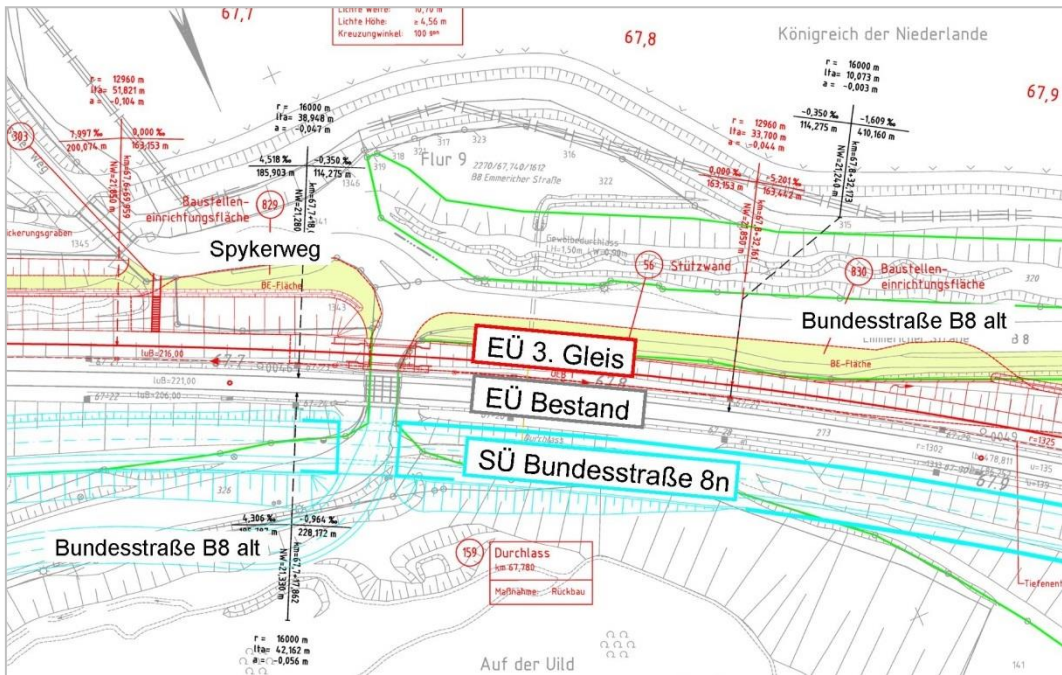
Lageplan DB AG / Lage der Bauwerke
